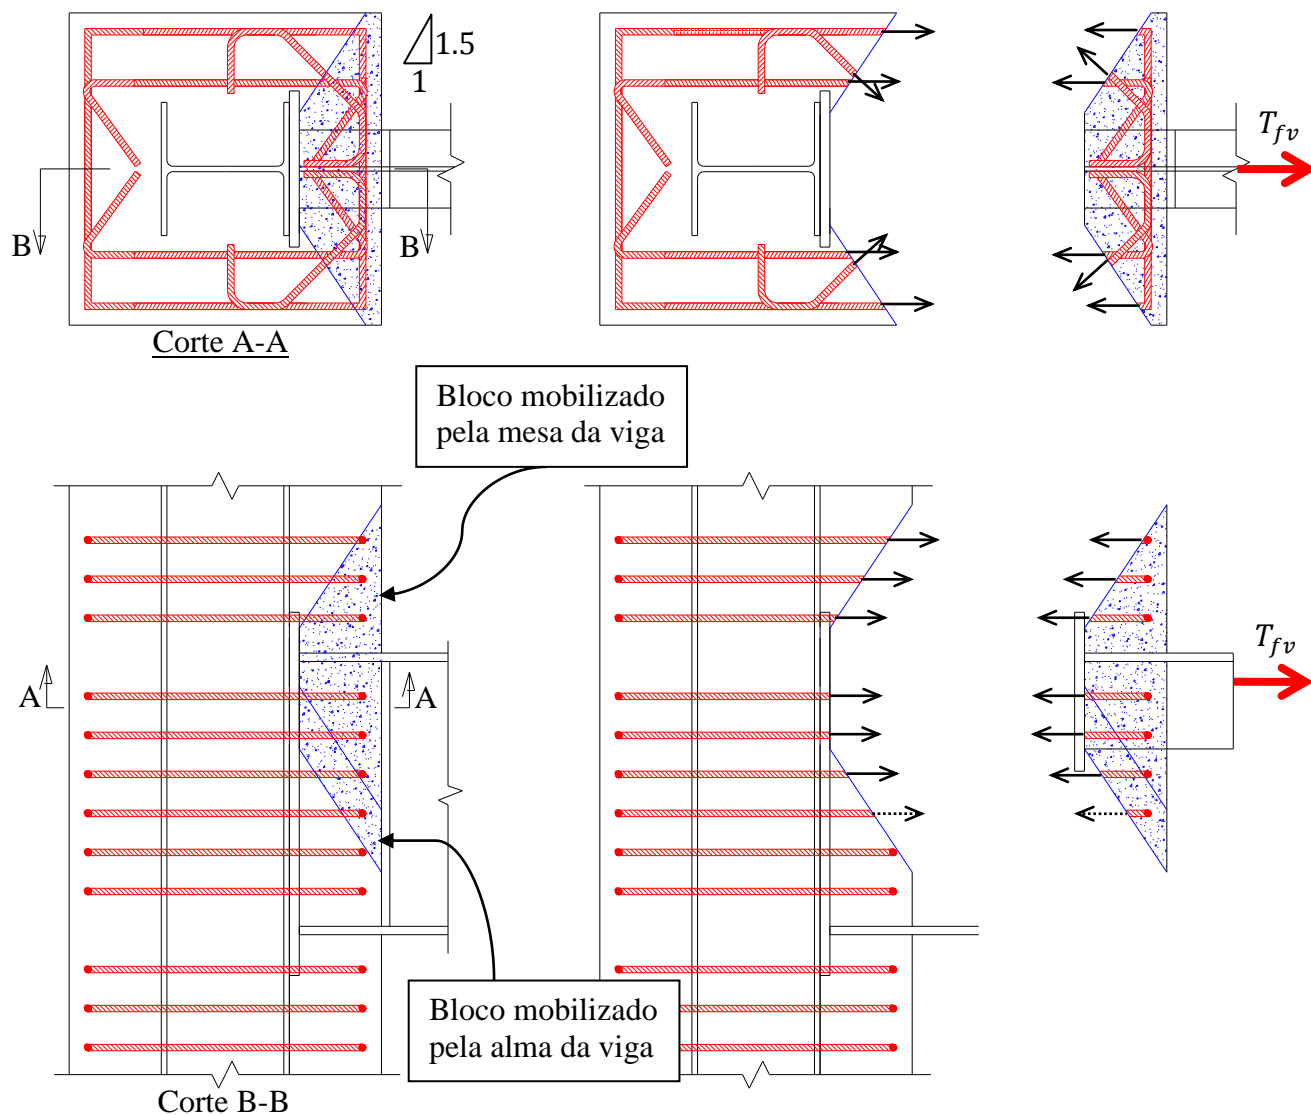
Identificação das barras de armaduras transversais efetivas
